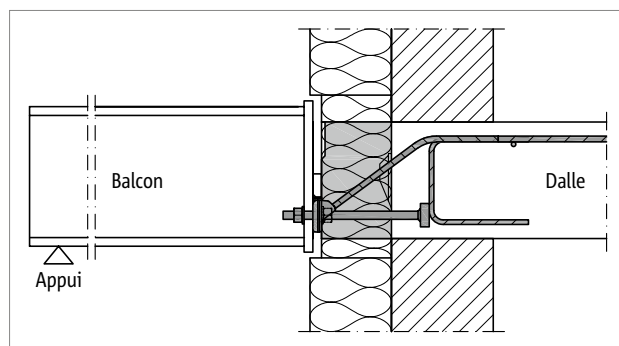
Schöck Isokorb® XT type SQ : raccordement à la dalle en béton armé ; corps isolant à l'intérieur de l'isolation thermique extérieure
